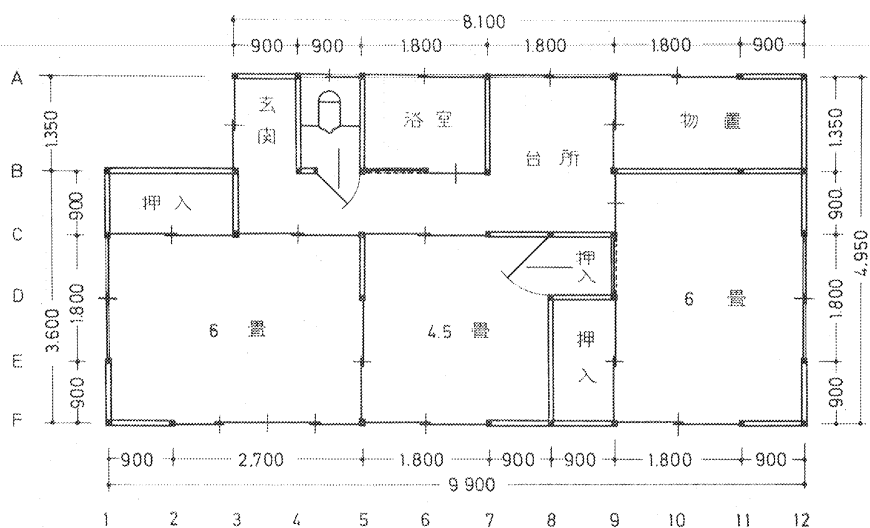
林業試験場職員宿舎 (65-Wc-1W 型) 平面図
